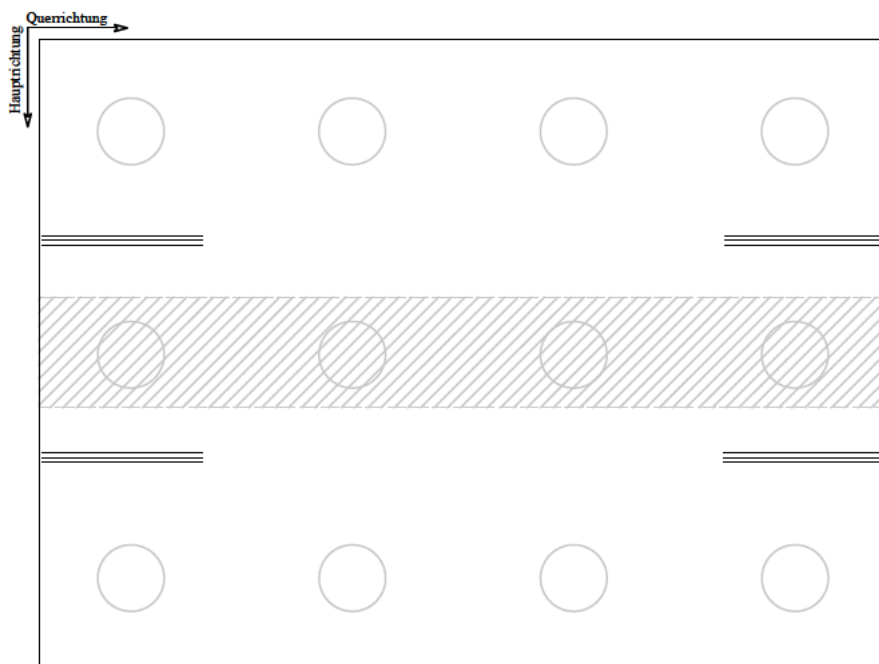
Variante 4 Lastfall 1 - Bewehrung oben
